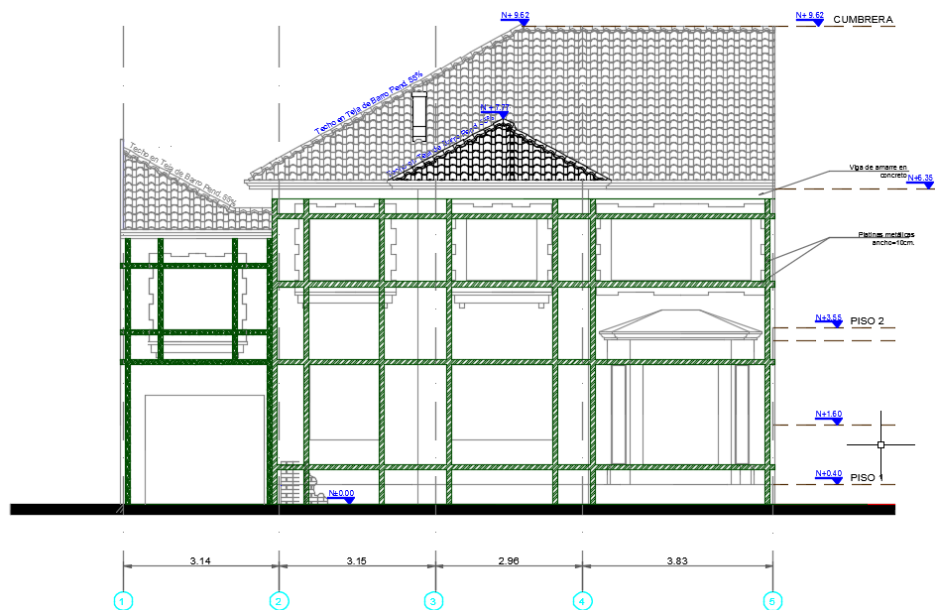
Distribución de las láminas de acero en la fachada principal de la casa ubicada en la carrera 18 # 34-15. Fuente: Planos de reforzamiento elaborados por el Ing. Manuel Antonio Ramirez Vargas
